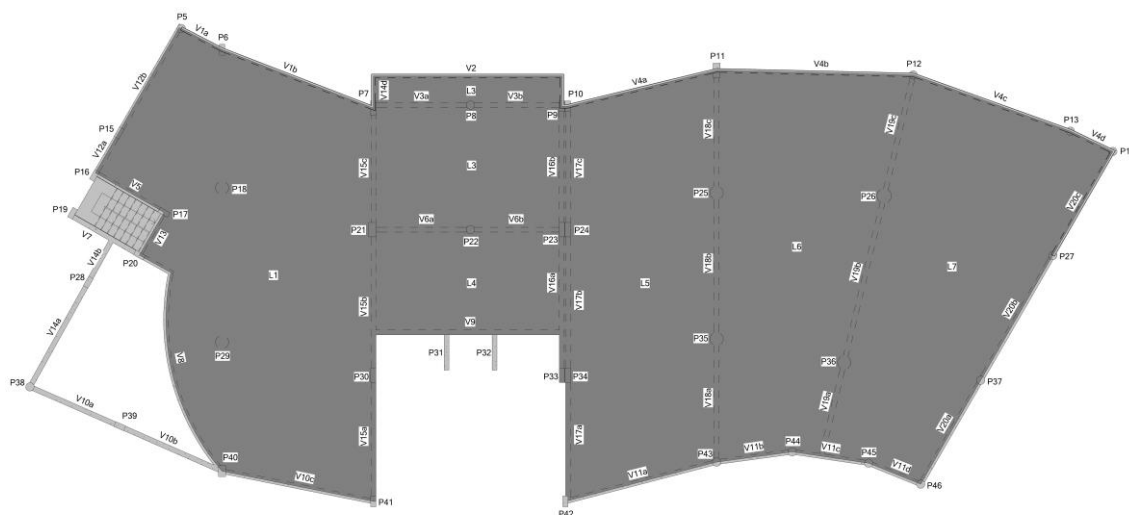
Planta Baixa Nível 2 (primeiro subsolo)
